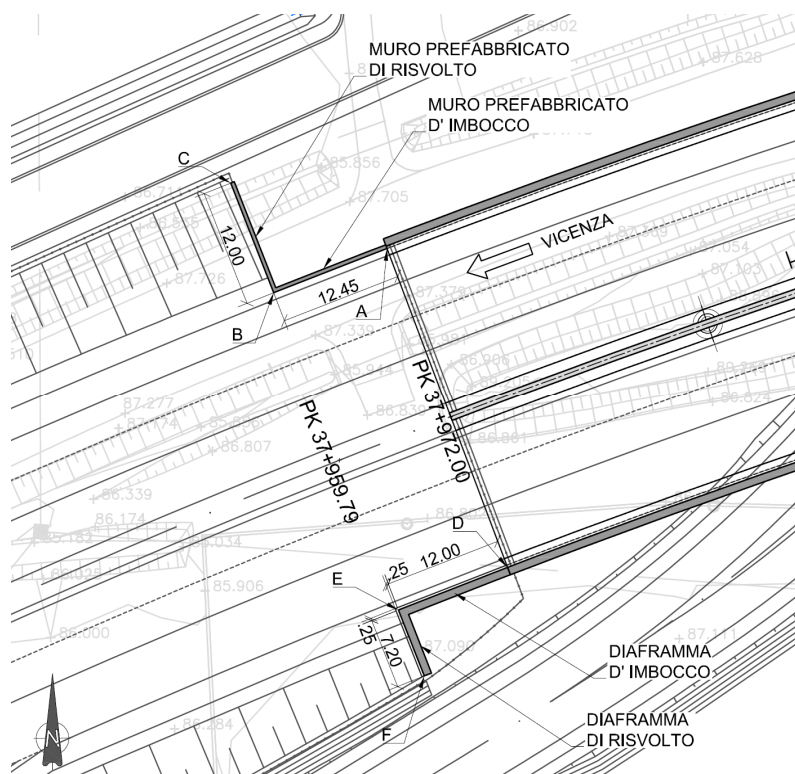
planimetria di tracciamento imbocco lato Vicenza.
